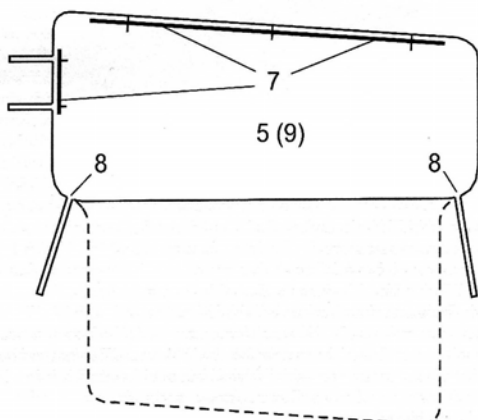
Поперечное сечение (А-А) выемочной камеры и заходки в слое у кровли пласта
